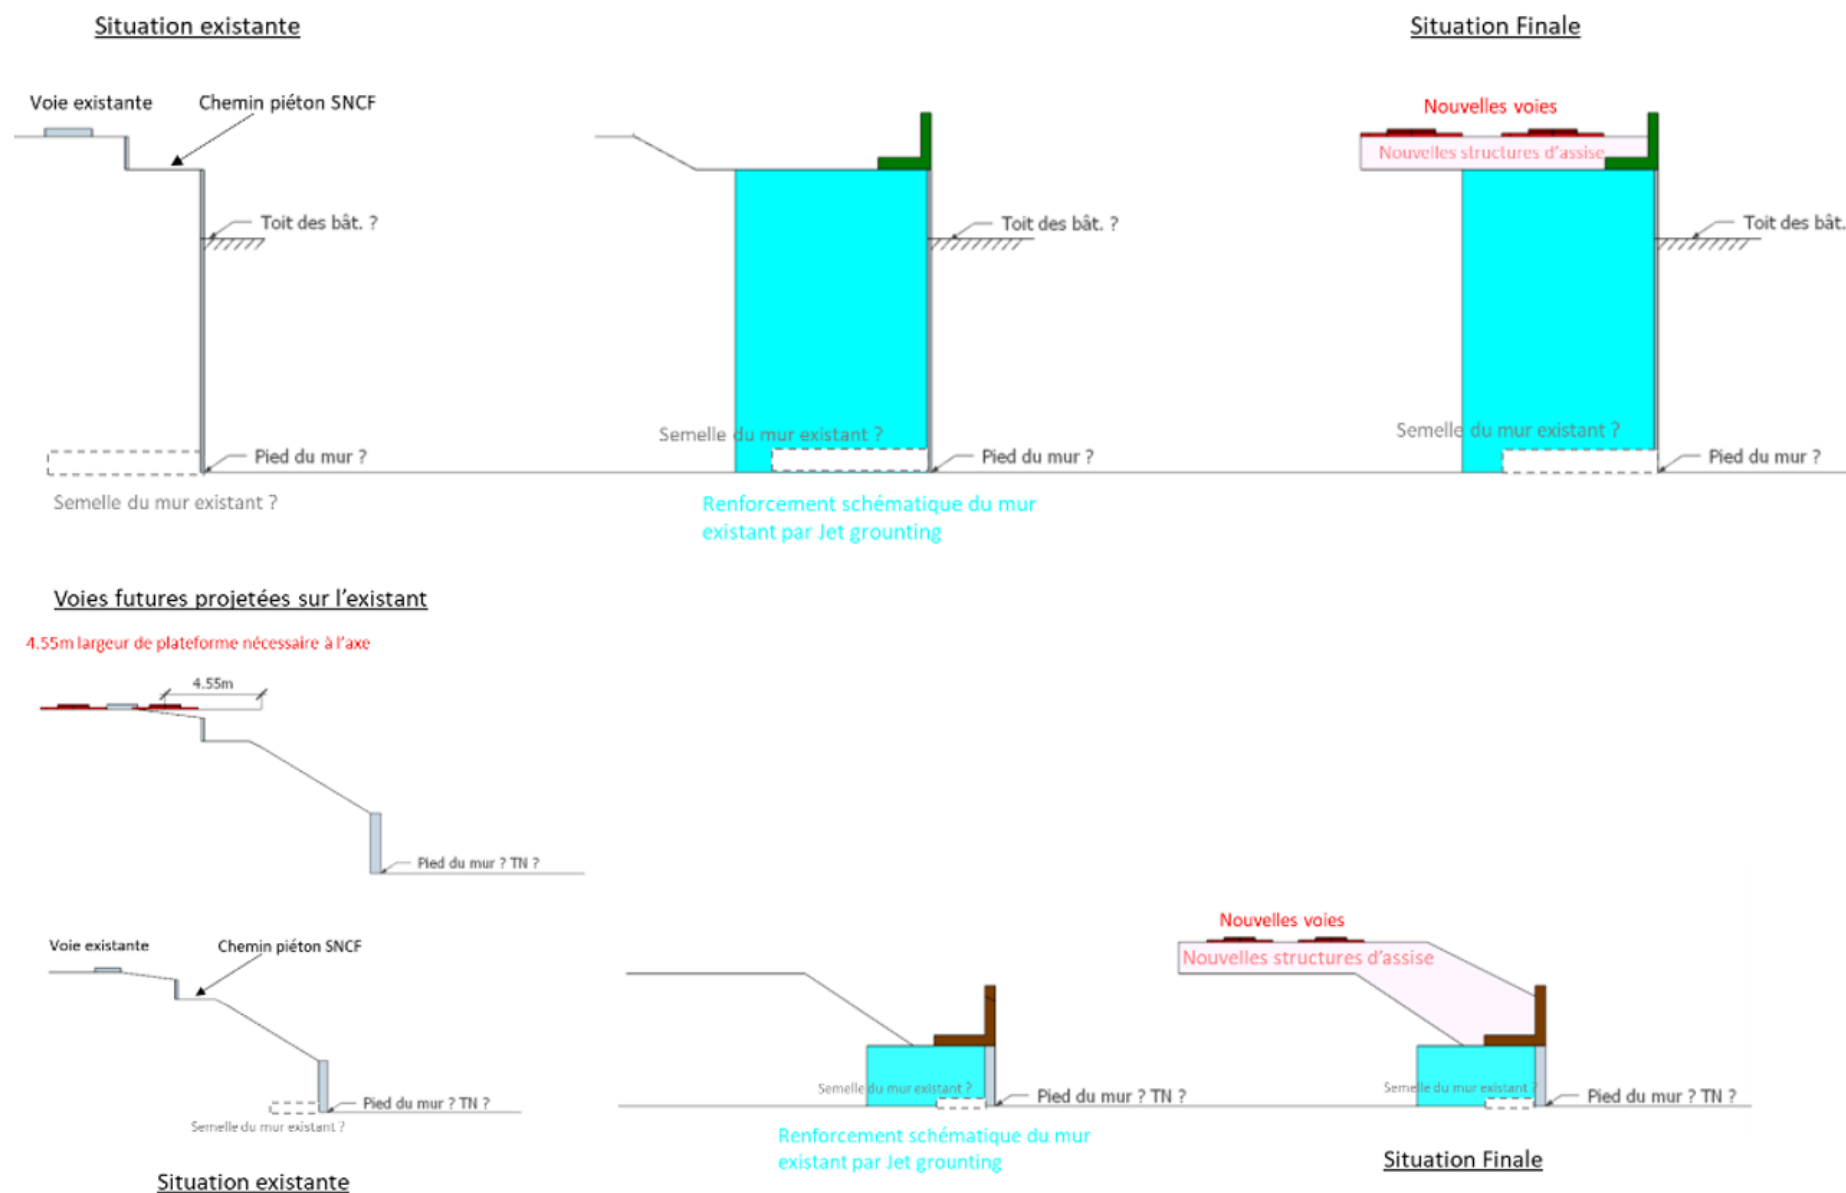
Principes de renforcement du mur existant par une injection de type Jet Grouting
